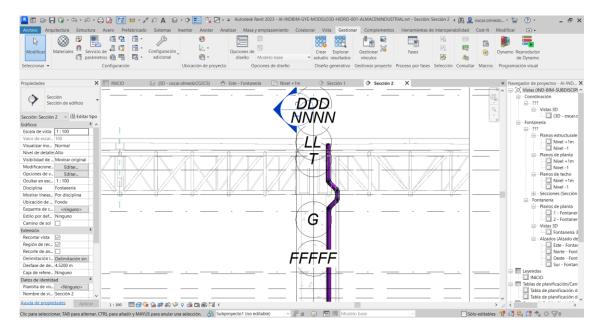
Detección de la colisión en corte o sección. Elaboración propia
